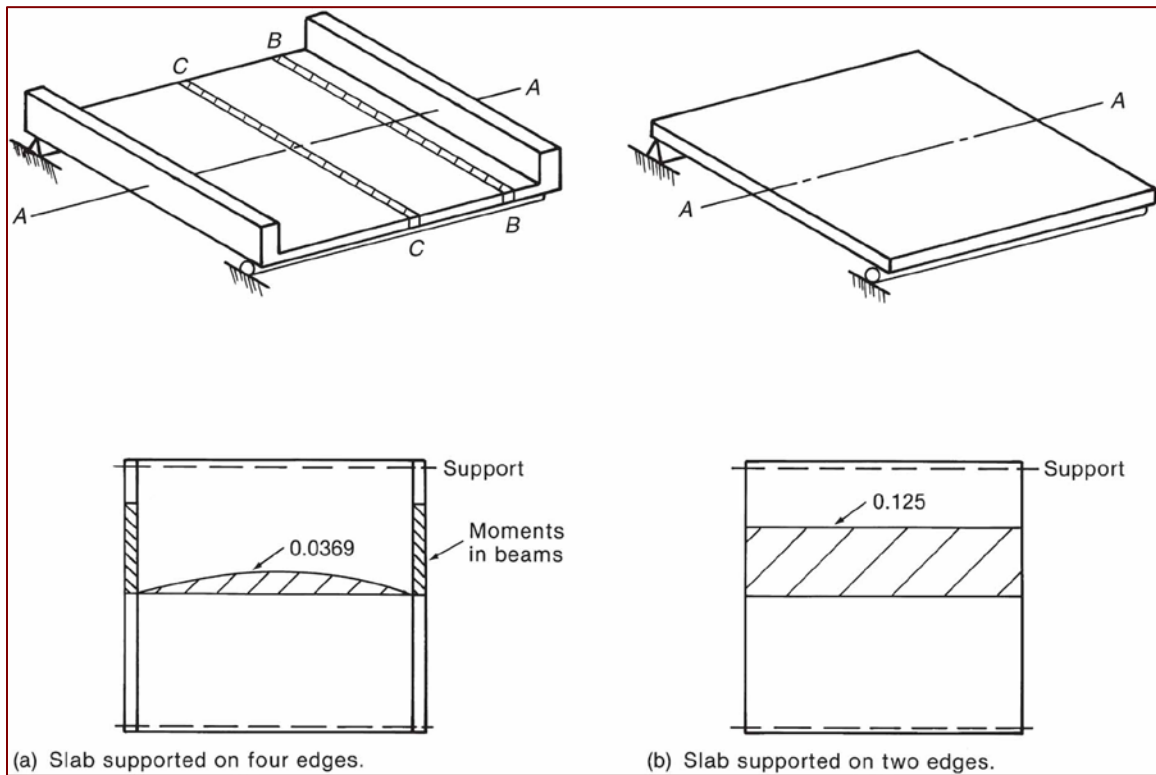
Efecto de la rigidez de las vigas de borde sobre los momentos en la losa.
